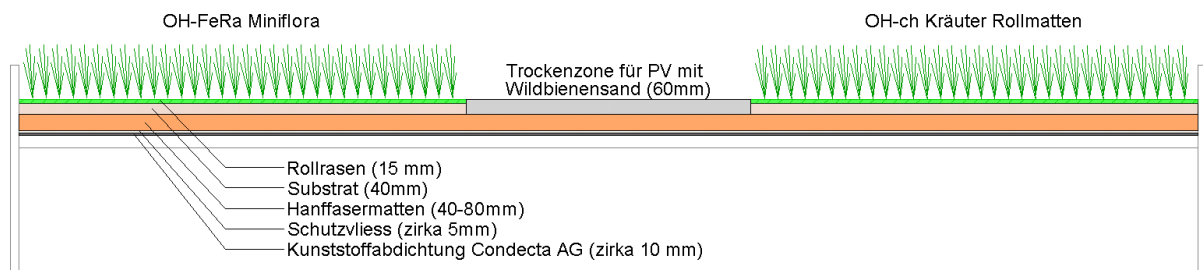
Seitenansicht Aufbau Dachbegrünung mit Schichtstärken
